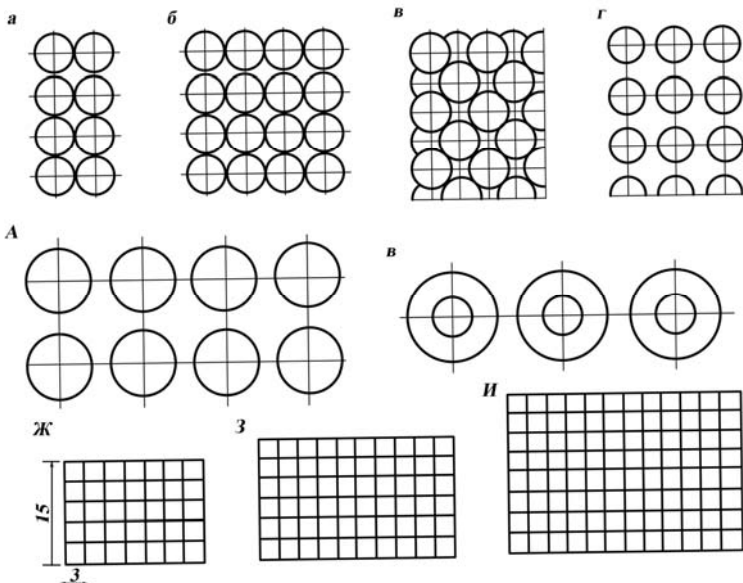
Схеми розташування в плані круглих і квадратних силосів з монолітного і збірного залізобетону:
